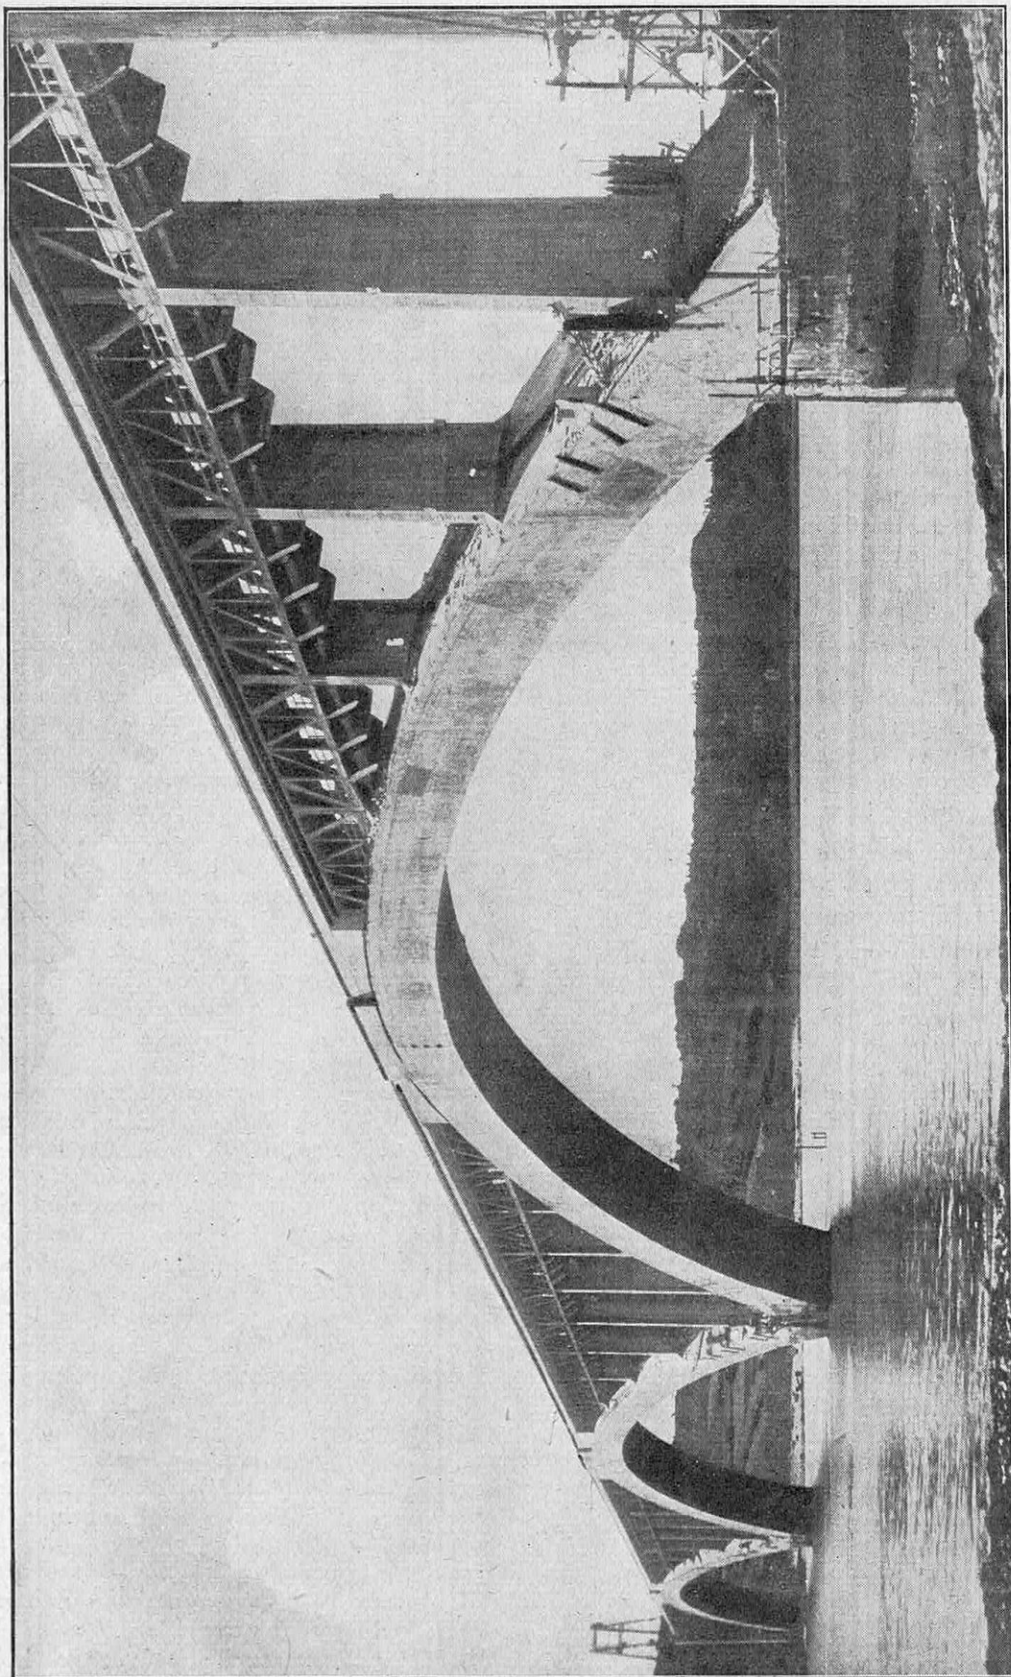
LE PLUS BEAU PONT DU MONDE EN BÉTON ARMÉ, CONSTRUIT A PLOUGASTEL, FACE A LA RADE DE BREST, COMPORTE TROIS ARCS DE 180 MÈTRES ET MESURE AU TOTAL 850 MÈTRES (VOIR « LA SCIENCE ET LA VIE », N° 135, PAGE 234)
